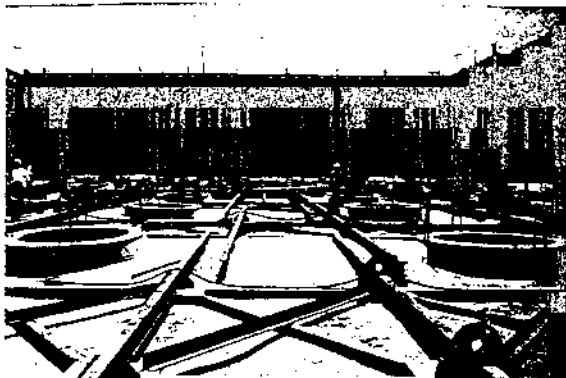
Particolare della platea di fondazione gettata in subacqueo : si notino le estremità superiori dei tralicci emergenti dal getto.
